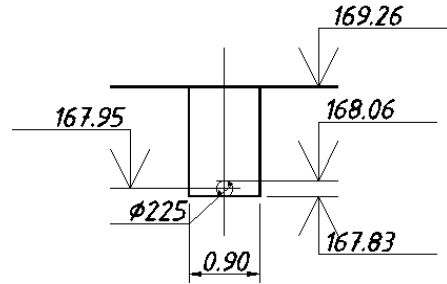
Поперечний переріз зрошувального трубопроводу МКр-1
